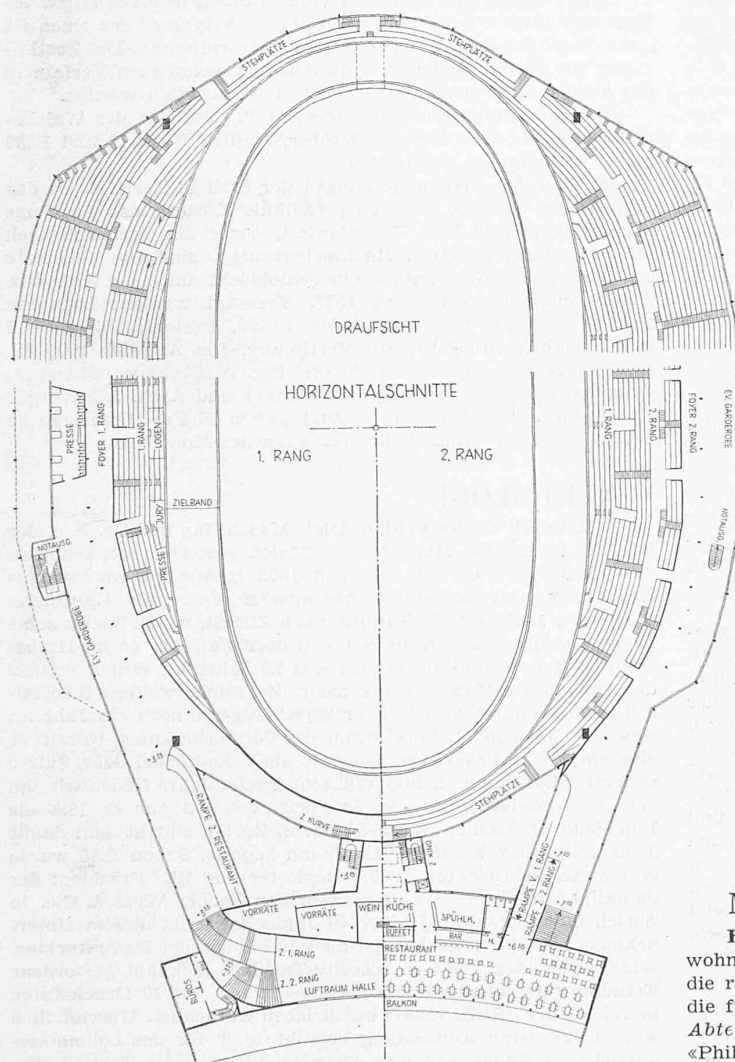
Grundriss vom 1. und 2. Rang mit Draufsicht. — 1 : 1000
